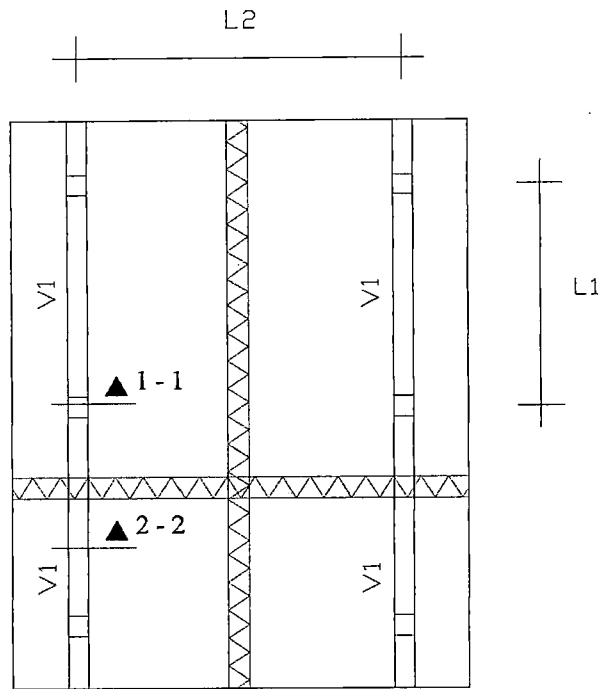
Vista en Planta de una Edificación que emplea Tridilosa (Estructuración B)
